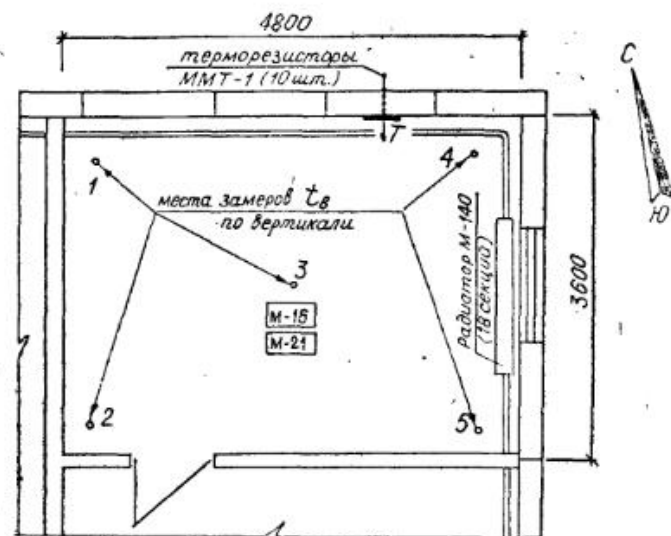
План опытной комнаты северо-восточной ориентации на первом этаже 24-квартирного жилого здания из деревянных панелей в пос. Сангар.
